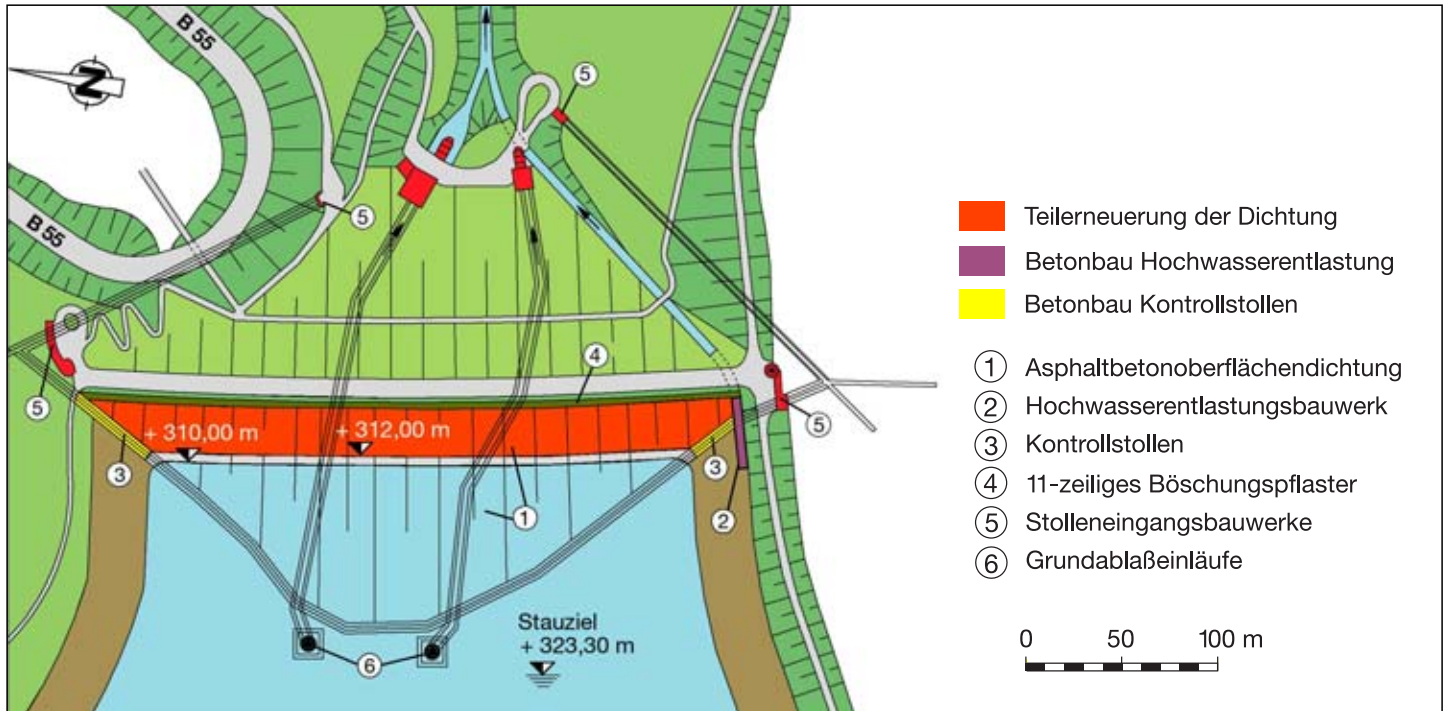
Lageplan des Henne-Damms mit eingetragenem Sanierungsumfang
